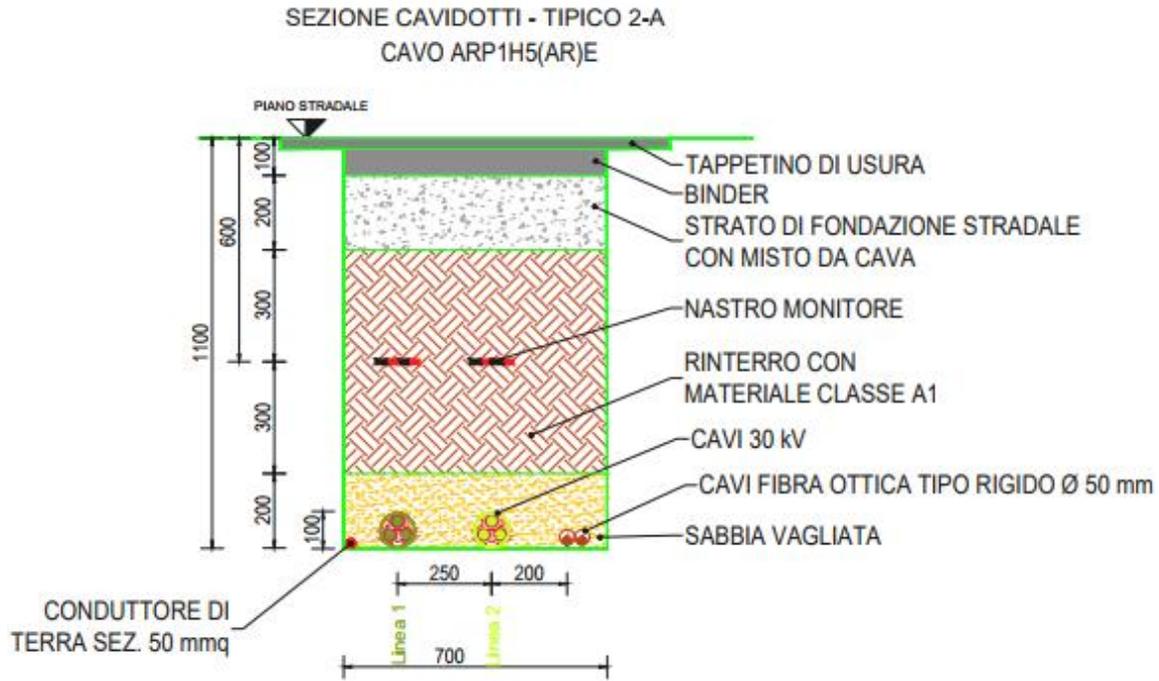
Sezione tipo di scavo – doppia terna MT su strada asfaltata (SP8)
